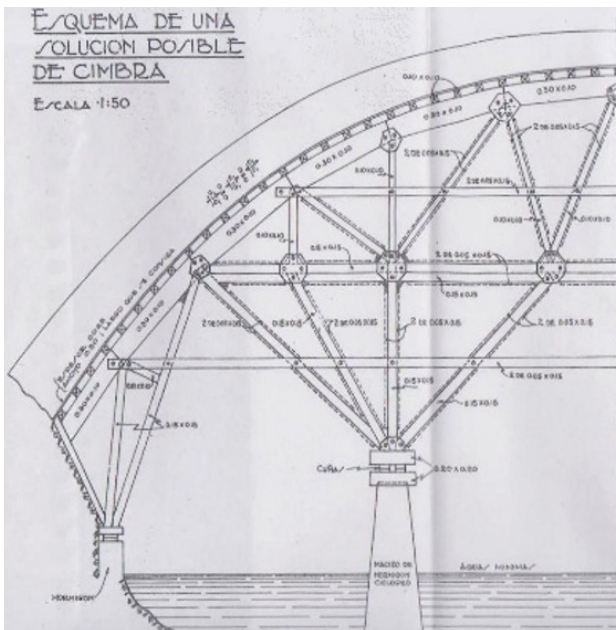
Cimbra para puente de arco de 10 m en hormigón simple.
